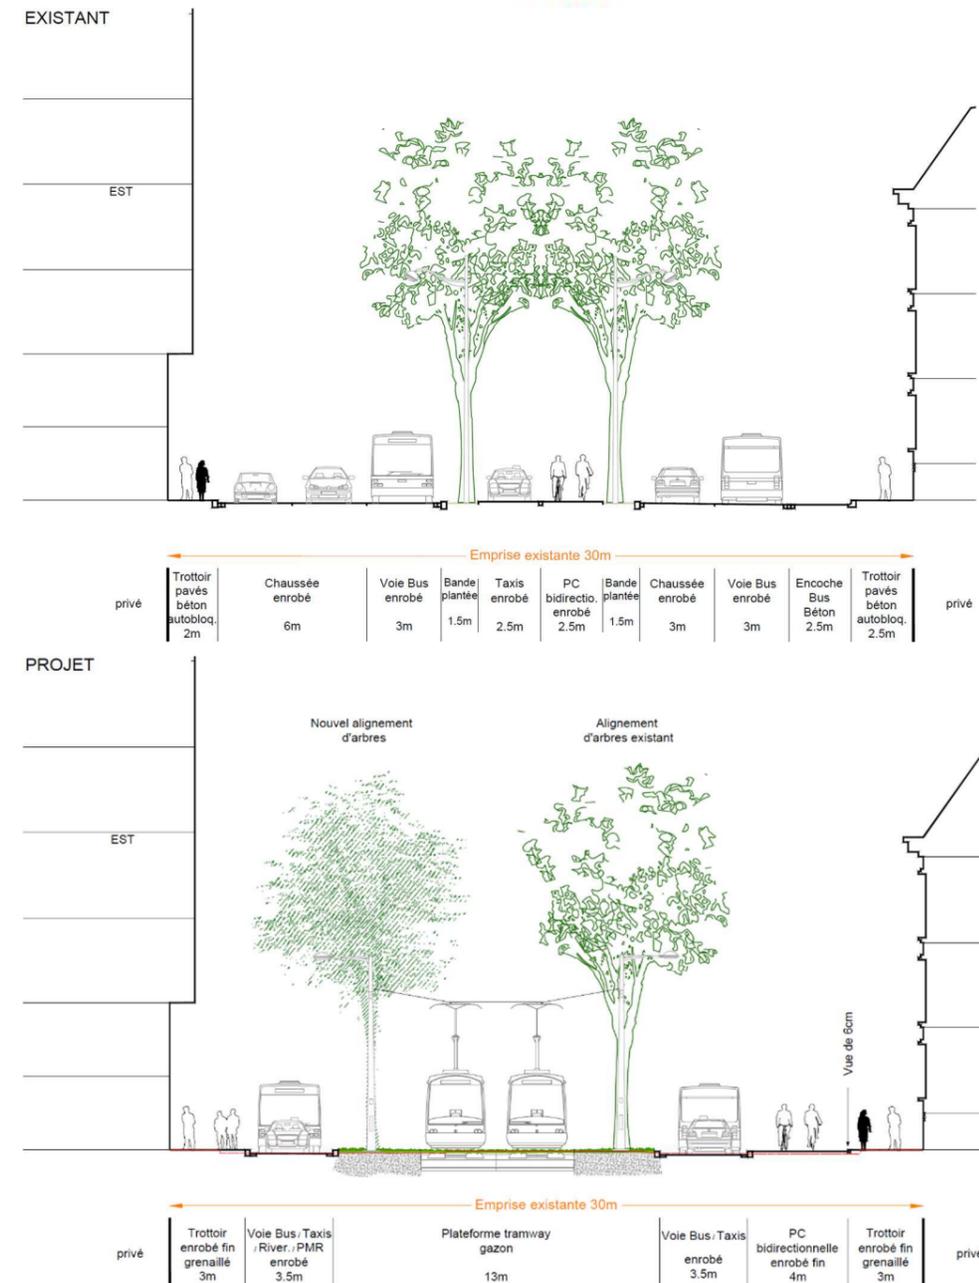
Coupe Boulevard de Metz (source : AVP GETAS 2023)
